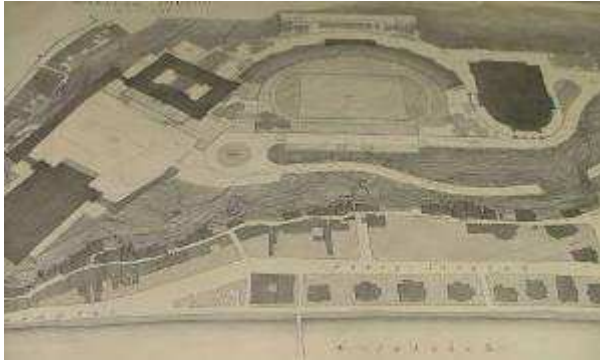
Otto Strohmayer, Lageplan, Imbergverbauung, Salzburg, zweite Projektphase, Variante B, Februar 1942 (HSS, INR 02-1614).
